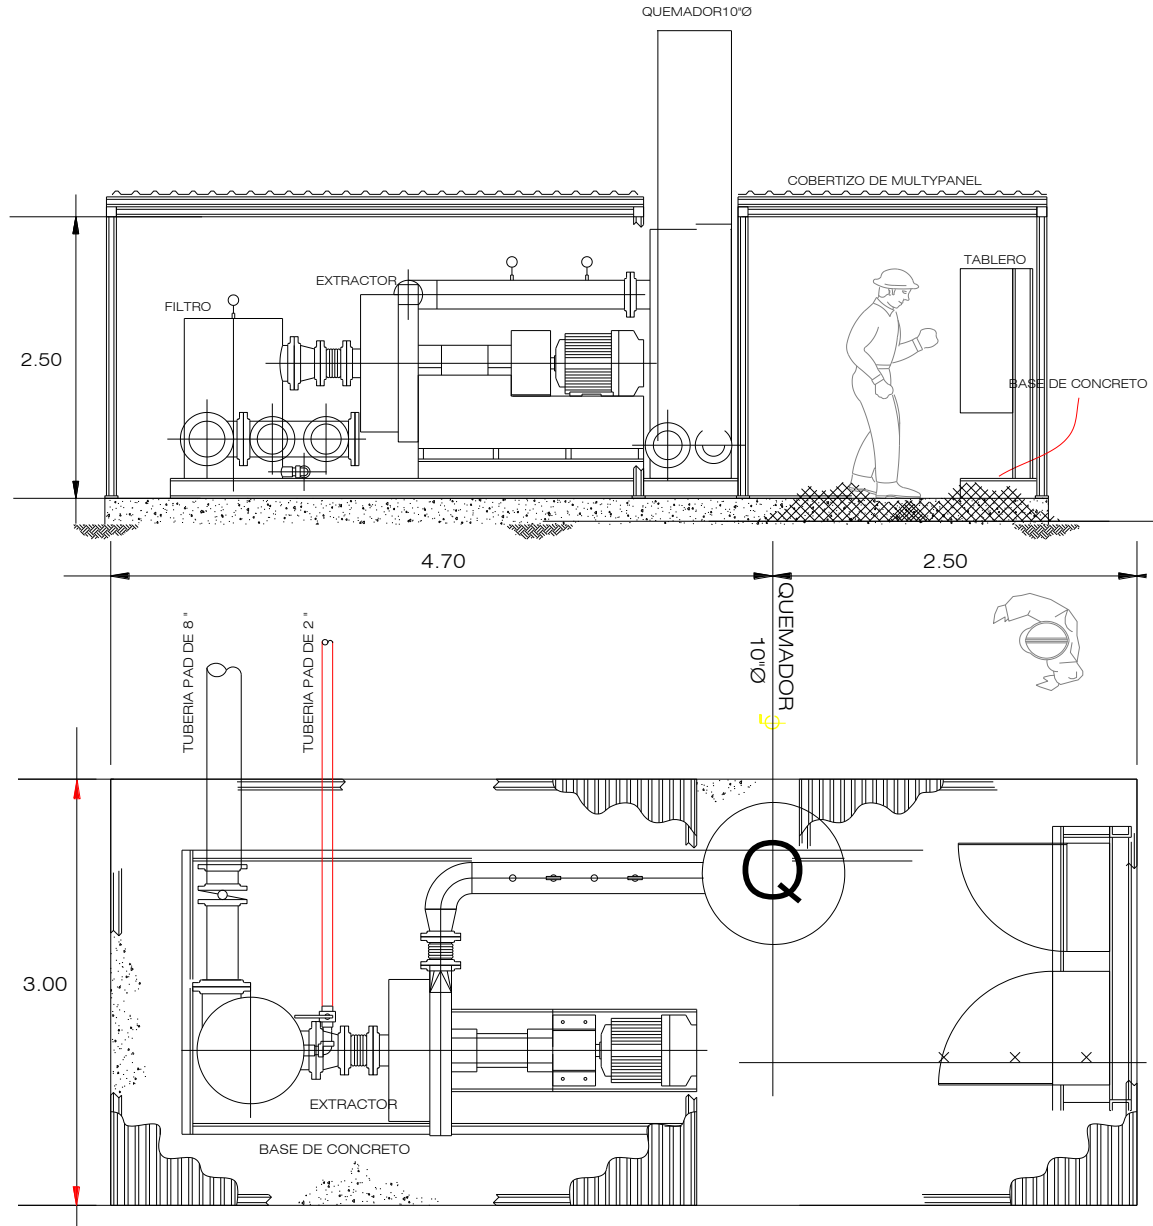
Planta y alzado del cobertizo para los extractores y quemador
